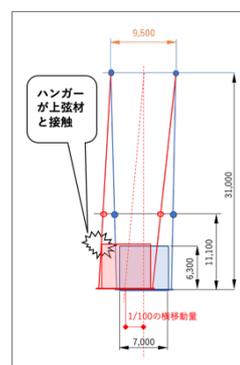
強風時変形状態 写真-2 下弦材定着点³⁾
